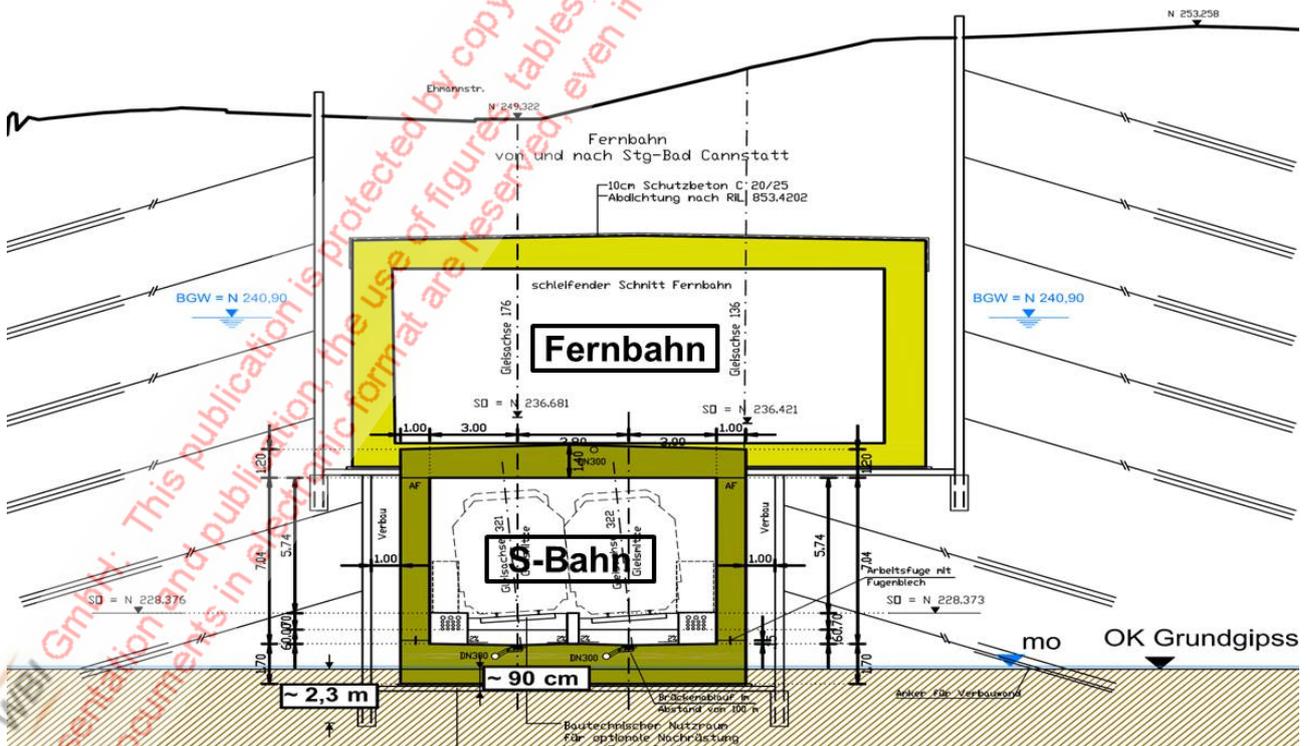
Offene Bauweise: S-Bahn-Tunnel, Schnitt Kreuzungsbauwerk
